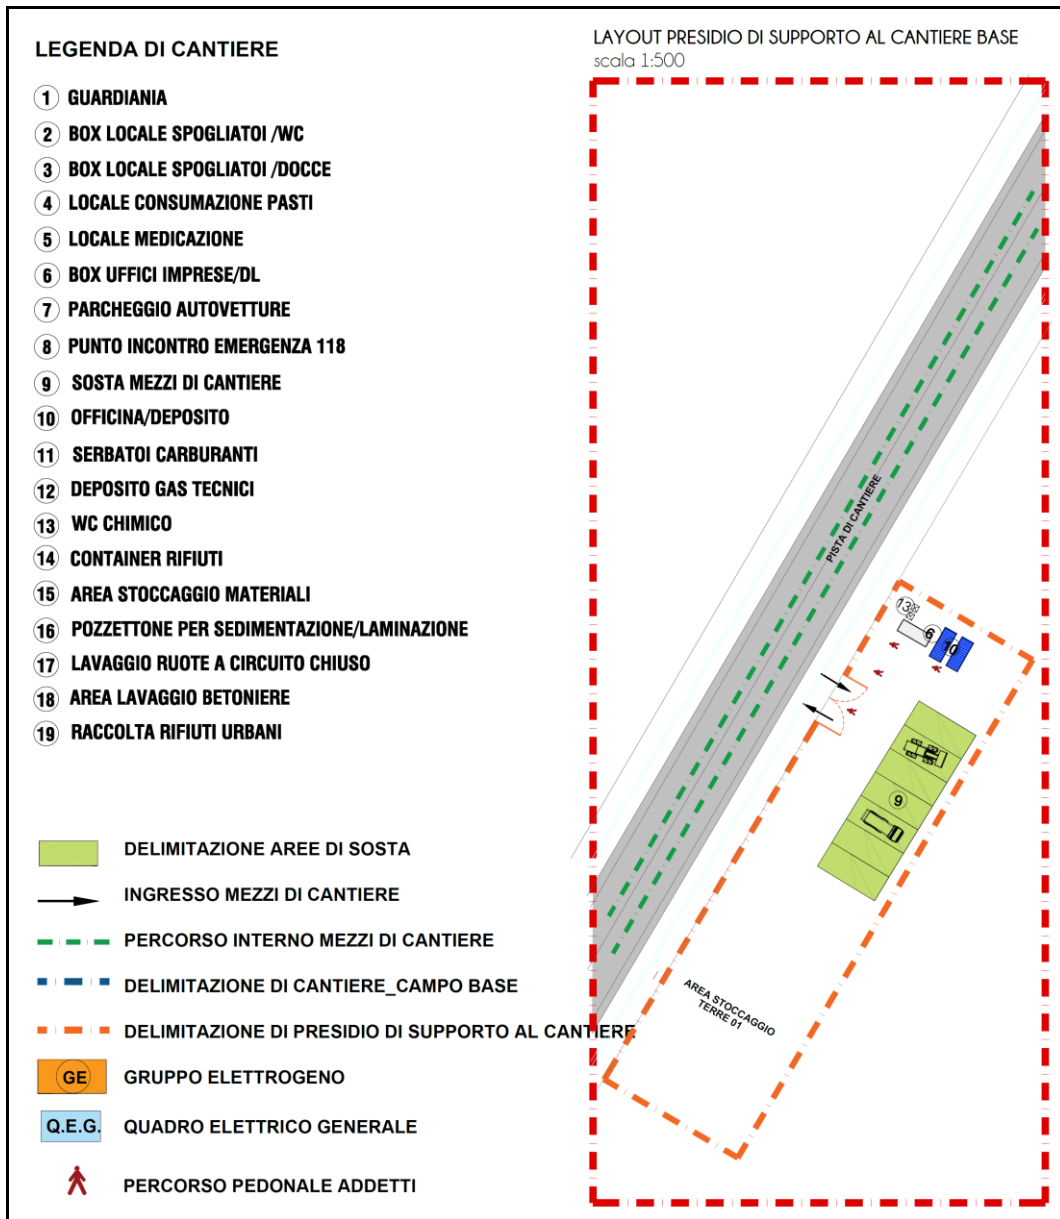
elaborati progettuali (planimetria generale cantiere, presidio di supporto e legenda)
